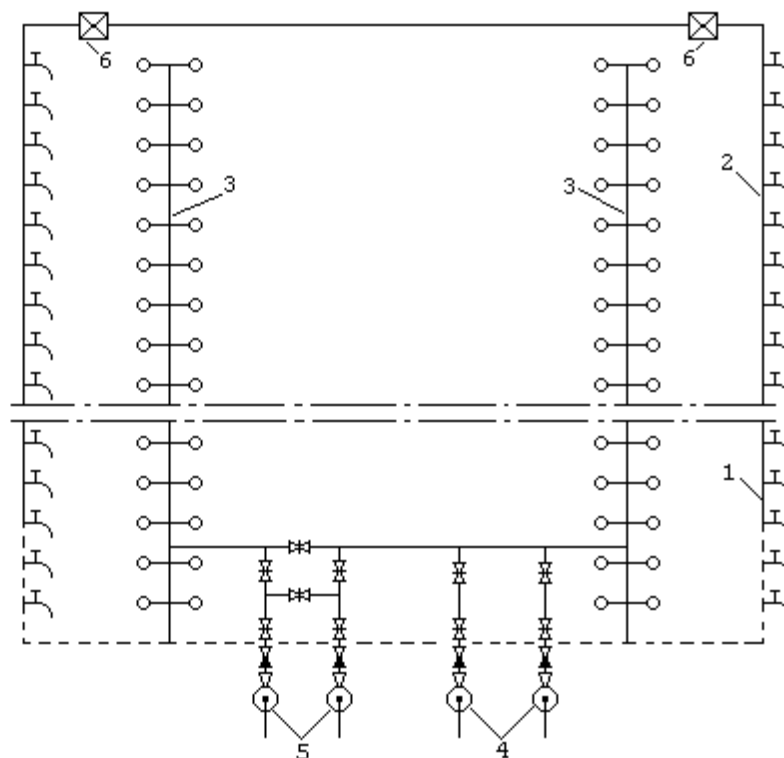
Схема объединенного водопровода 22-этажного здания
